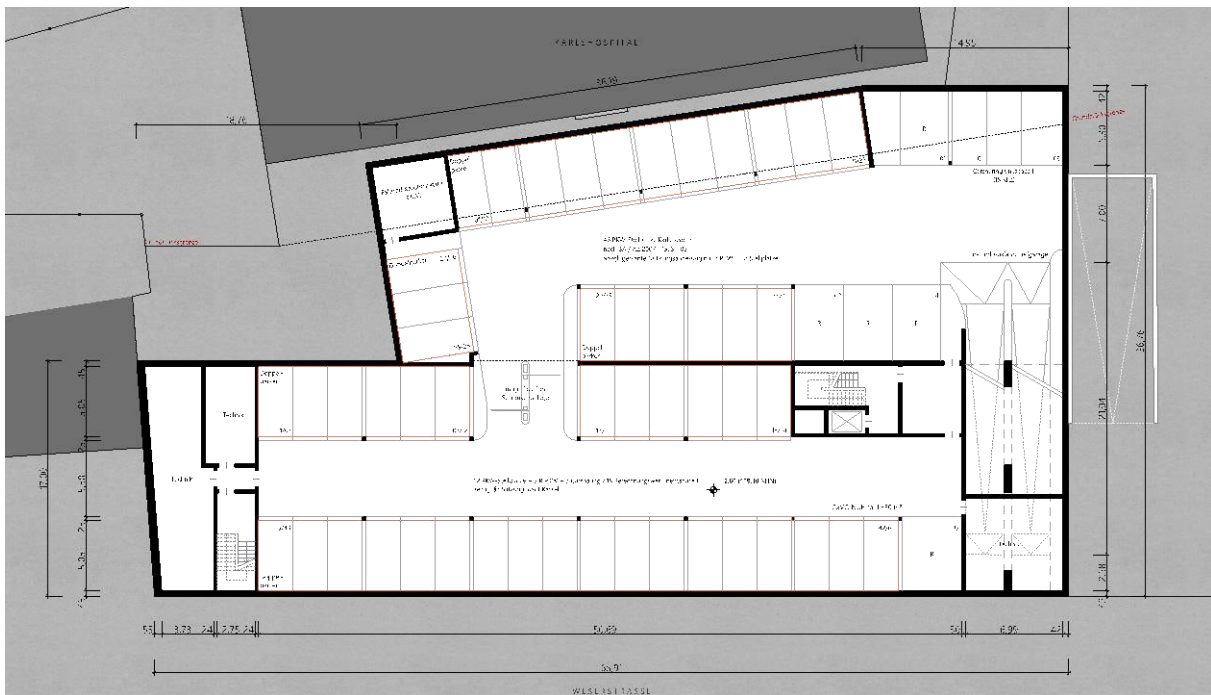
Vorhaben- und Erschließungsplan - Grundrissplan Tiefgarage – Stand: Offenlage August 2023
